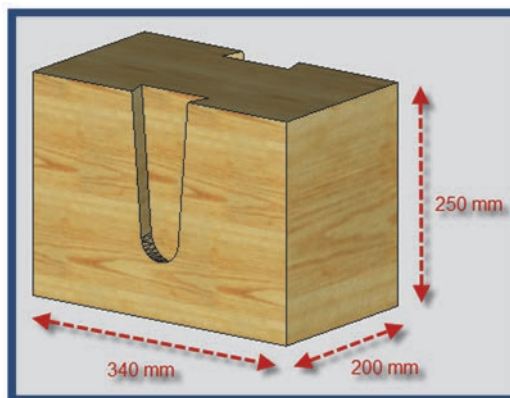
Probeta de madera laminada de castaño de sección de viga con mortajas talladas que reciben a las viguetas (diseño CAD)
